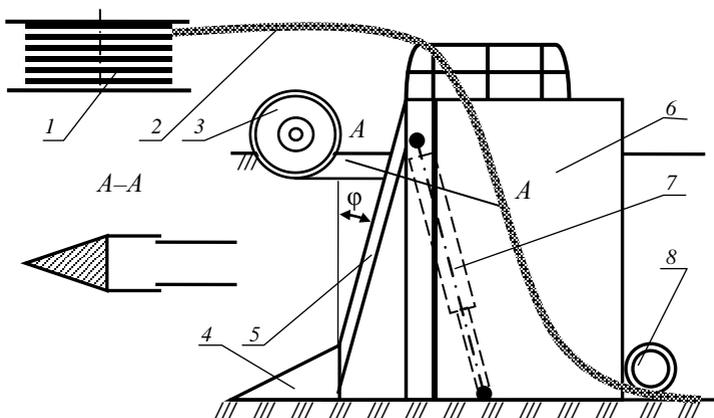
Схема рабочего органа дреноукладчика МД-12: 1 – барабан; 2 – дренажная труба; 3 – дисковый дернорез; 4 – носовина; 5 – нож; 6 – щиты боковые; 7 – гидроцилиндр рабочего органа; 8 – прижимной ролик
